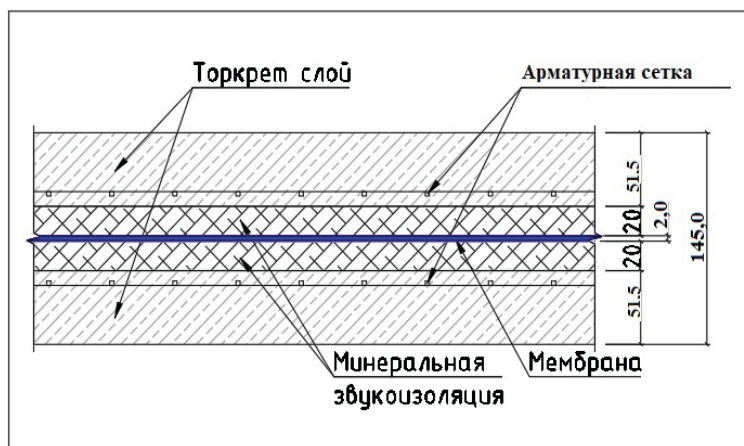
Расчёт индекса изоляции воздушного шума R_w для бескаркасной звукоизоляционной монолитной перегородки толщиной 145 мм, состоящей из пяти слоёв: гипсобетон (облицовка) — 51,5 мм с двух сторон + плита звукопоглощающая SoundGuard ЭкоАкустик 80 — 20 мм + сердечник из звукоизоляционной мембраны SoundGuard Membrane 2S — 2 мм + плита звукопоглощающая SoundGuard ЭкоАкустик 80 — 20 мм.
